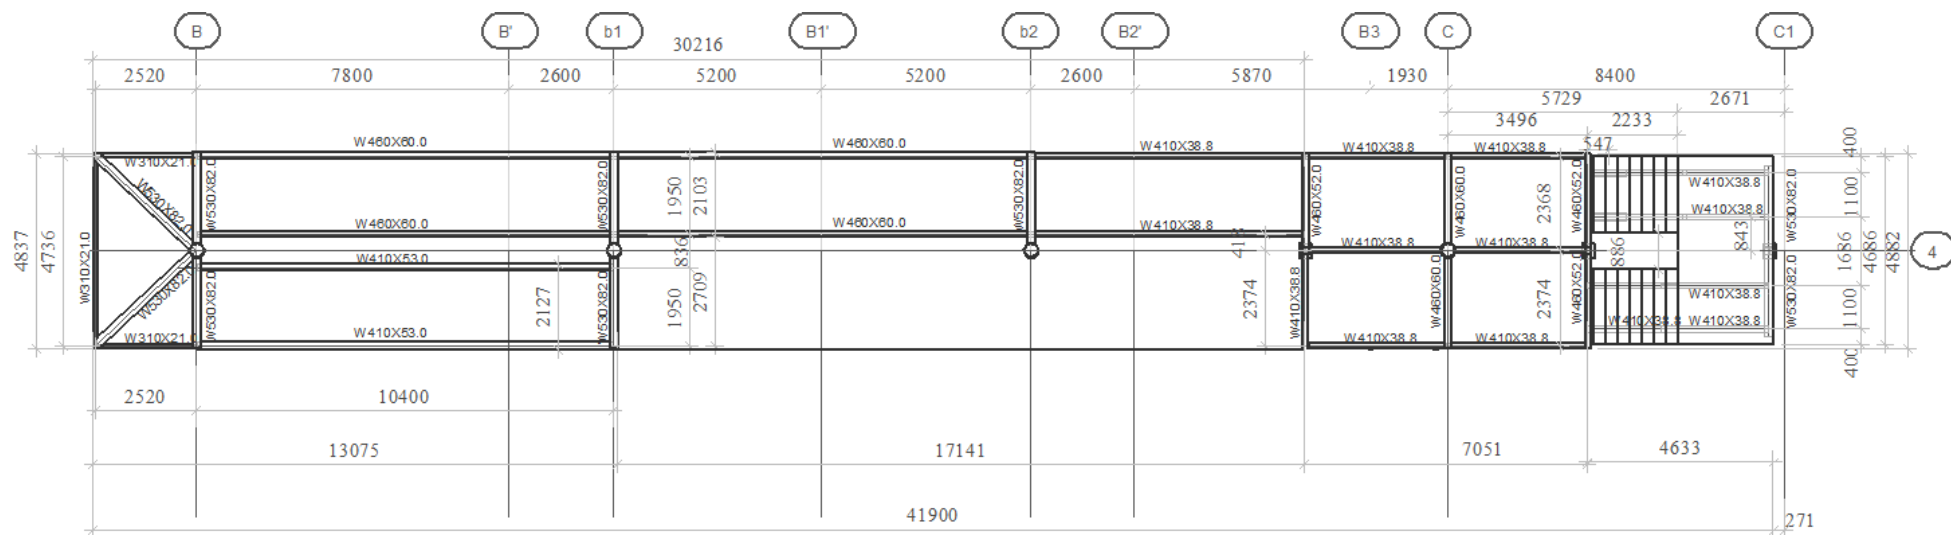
Planta de Elevação Nível + 0 até 2800.
